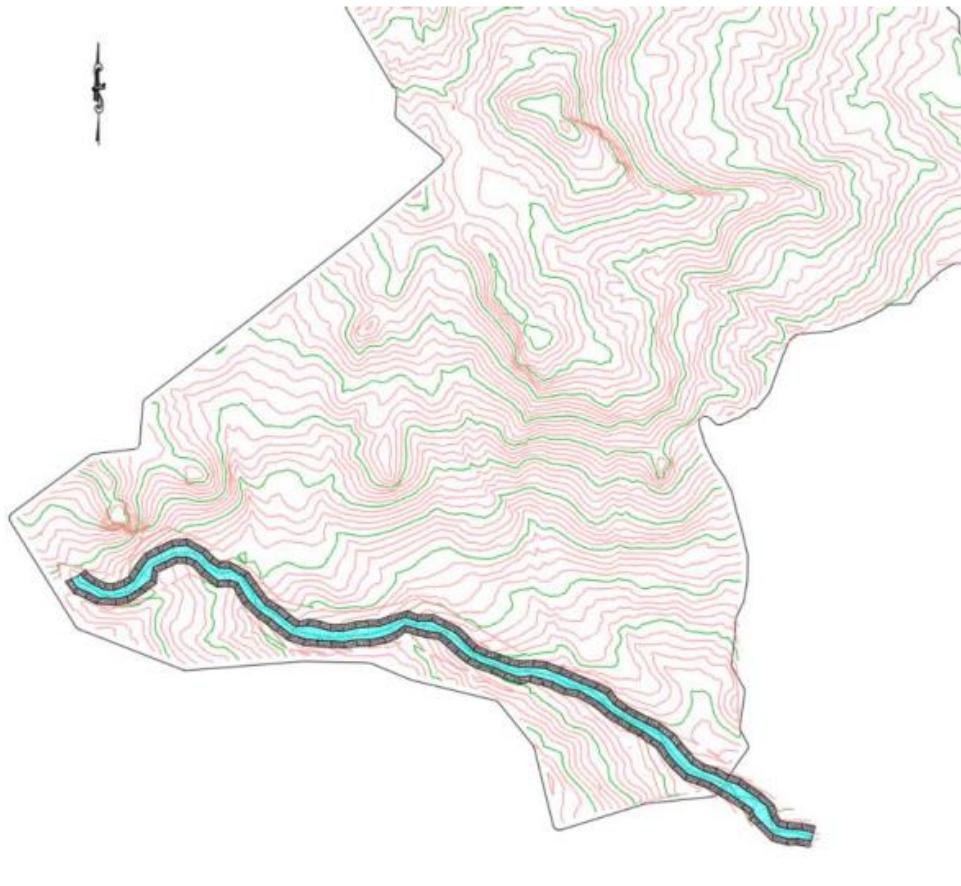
Planta de Secciones y Alineamiento – Quebrada Corral
